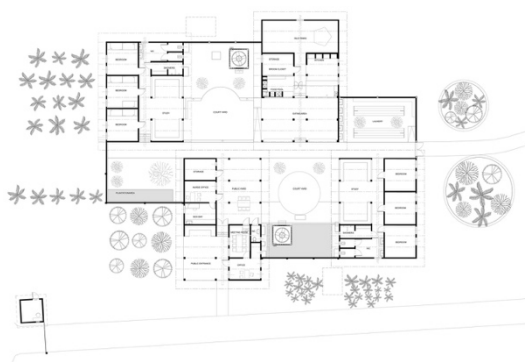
Planta do Centro Comunitário Infantil Econef (ArchDaily, 2018)
